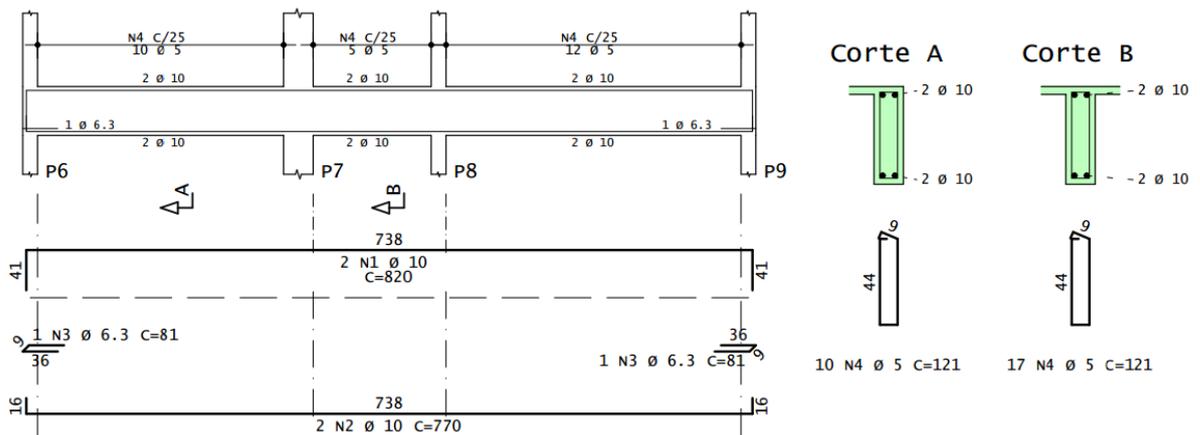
Armadura da viga V4 – pavimento superior (nível +3,00)
